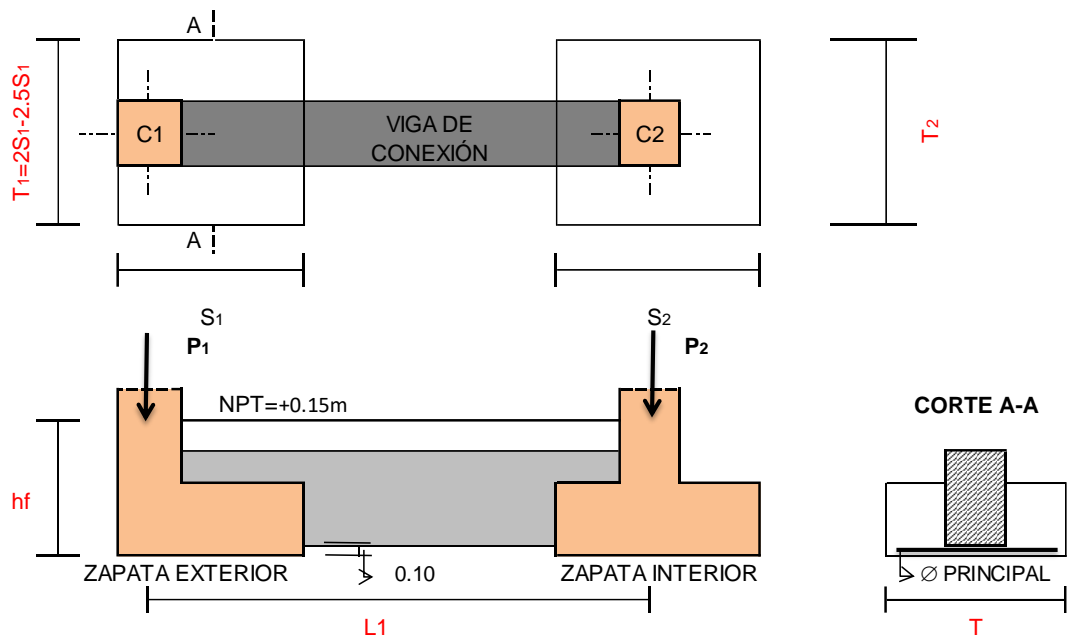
Diseño de Zapatas y Viga de conexión (Inicial)
